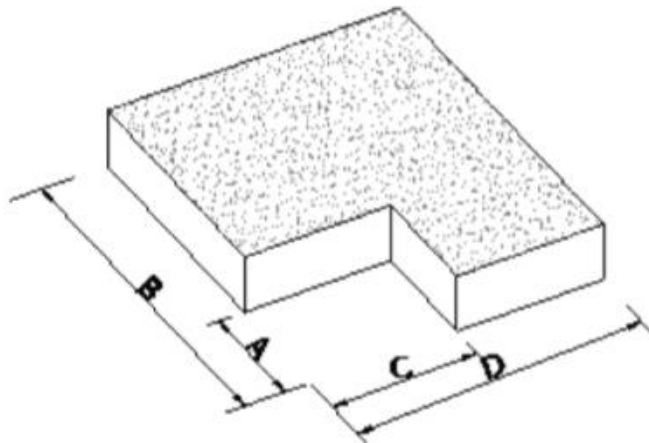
Retrocesos excesivos en las esquinas (Irregularidad en Planta Tipo 2)
